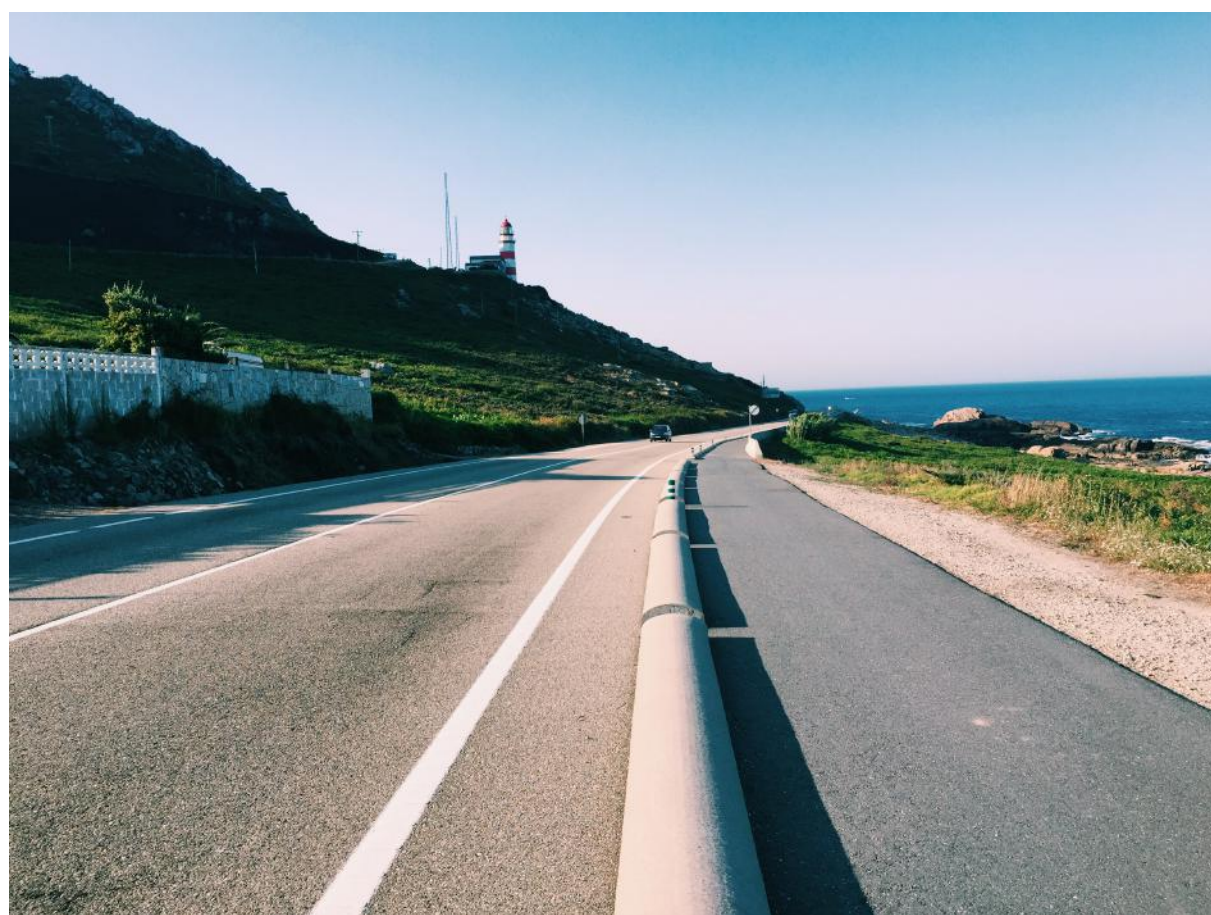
SECCIÓN TIPO CARRIL-BICI A SU PASO POR CABO SILLEIRO.
